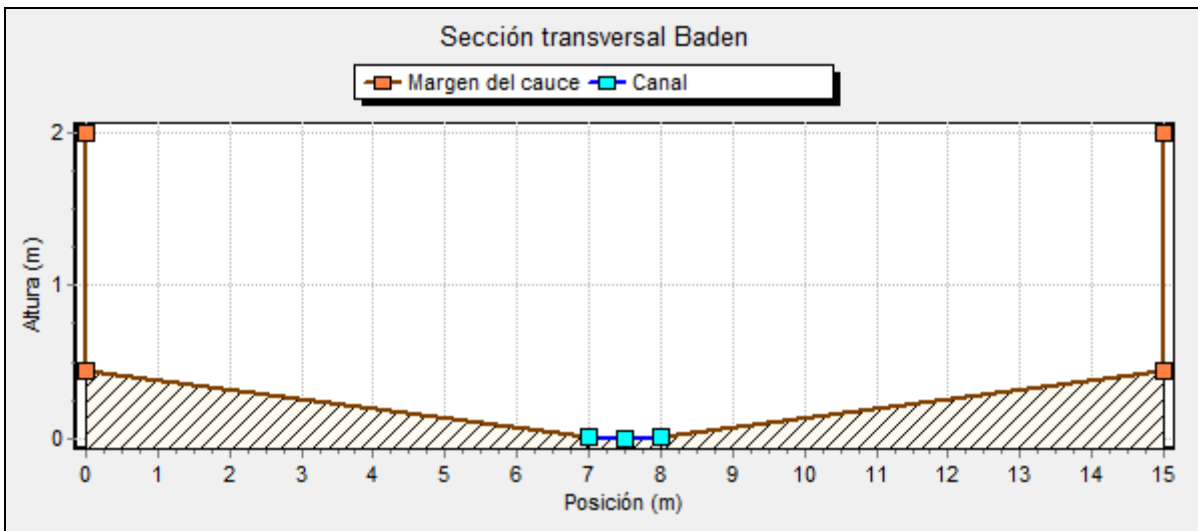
Sección transversal de badenes de hormigón en calzadas de empedrado o pavimento flexible.
